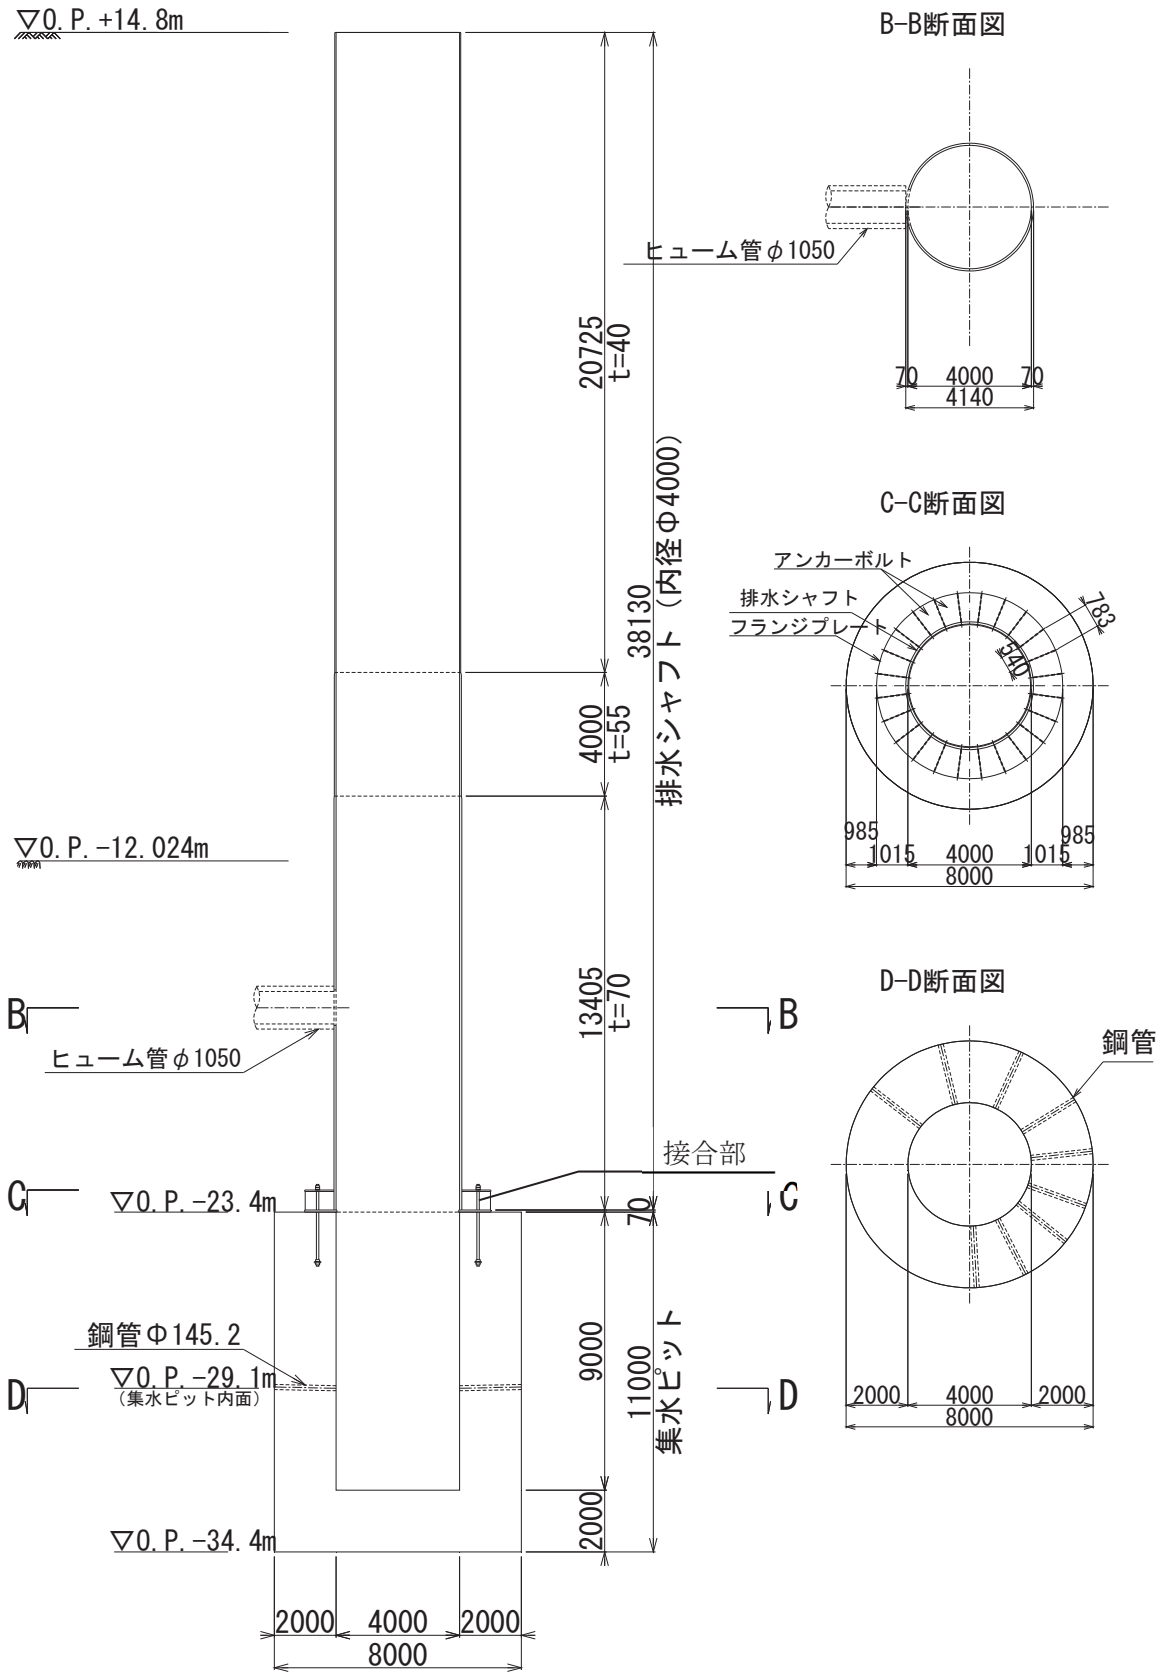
(4) No. 4 揚水井戸 構造概要 (単位: mm)
